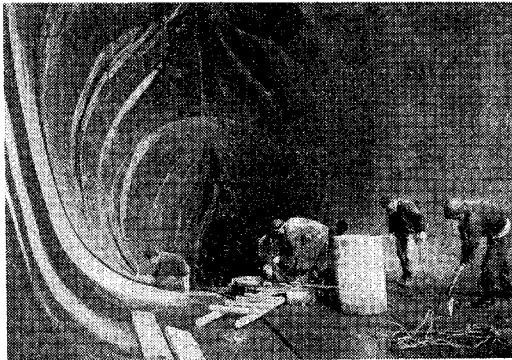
トンネル余水吐（バケットカーブより斜坑を望む）
